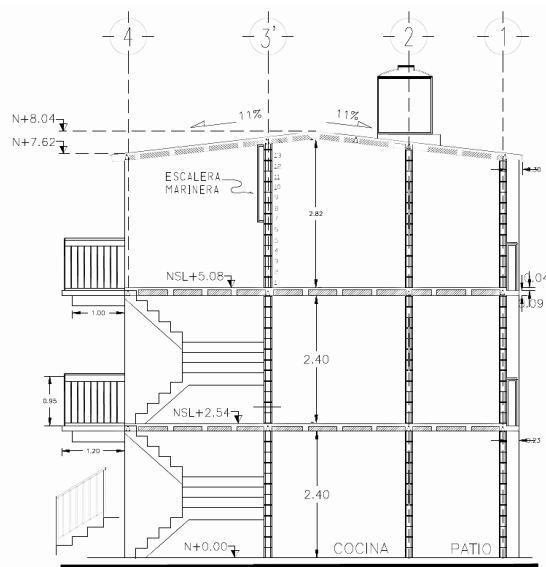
Corte transversal del conjunto. Fuente: Registro Único de Vivienda
